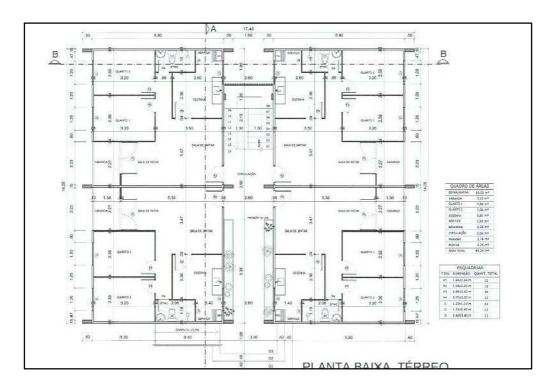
Planta Baixa do Pavimento Térreo do Bloco Habitacional.
